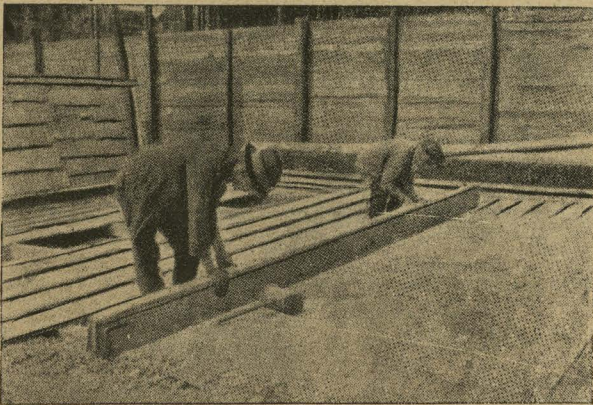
Wlewanie masy betonowej do połowy przekroju.
